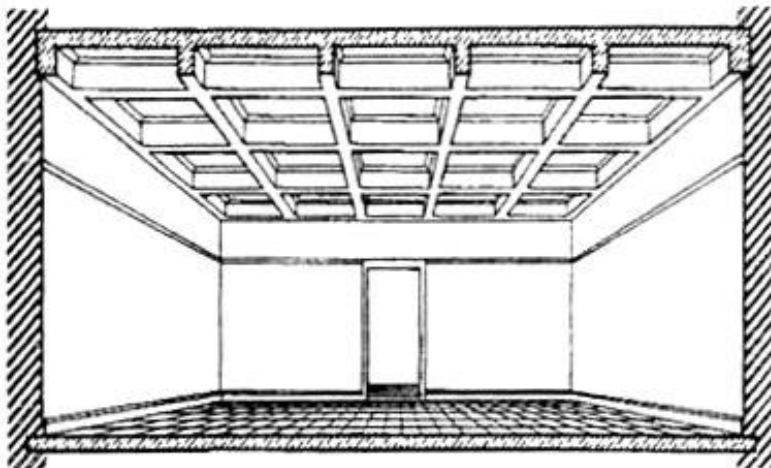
Общий вид железобетонного монолитного кессонного перекрытия
